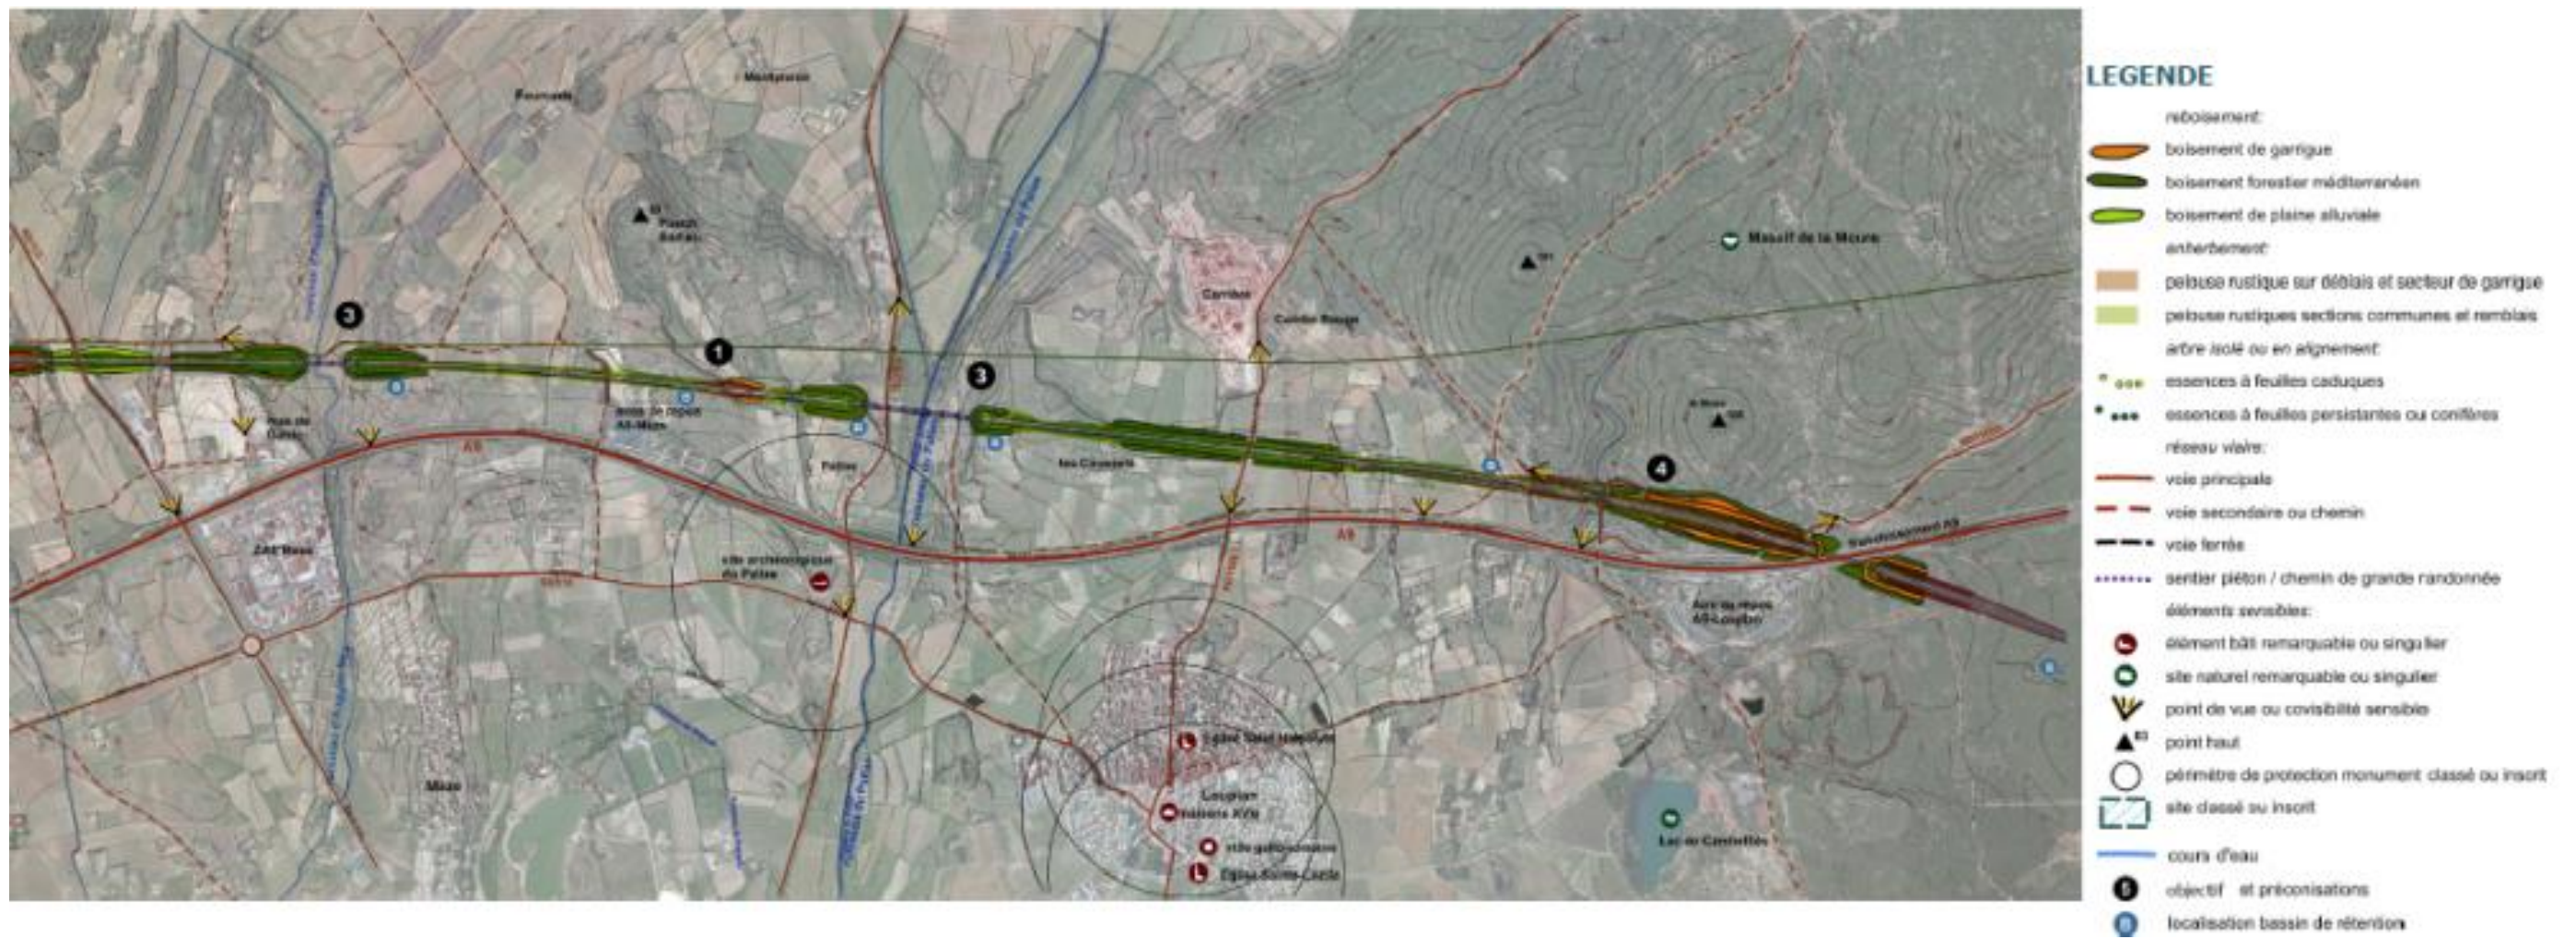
plan des mesures paysagères dans la traversée de la via Domitia, collines du bassin de Thau et Loupian (planche 2) (source : Traverses)
